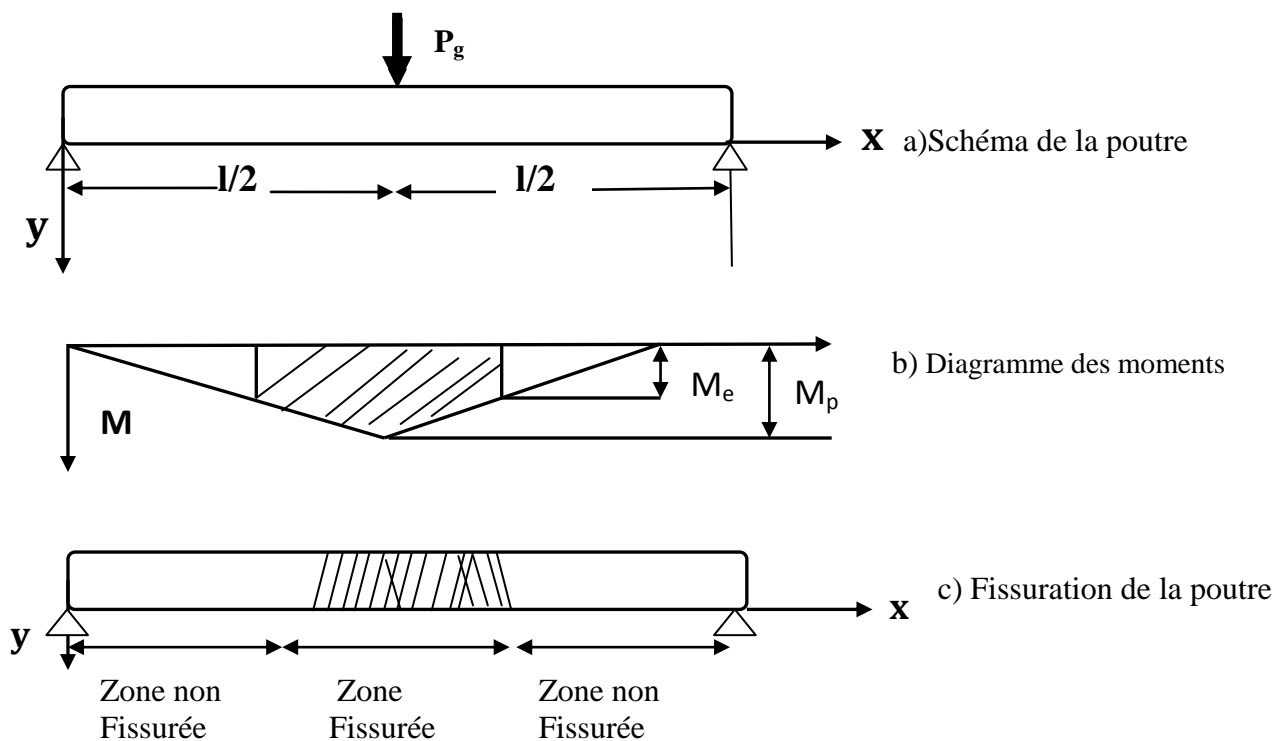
Comportement d'une poutre en béton armé sous charge croissante
